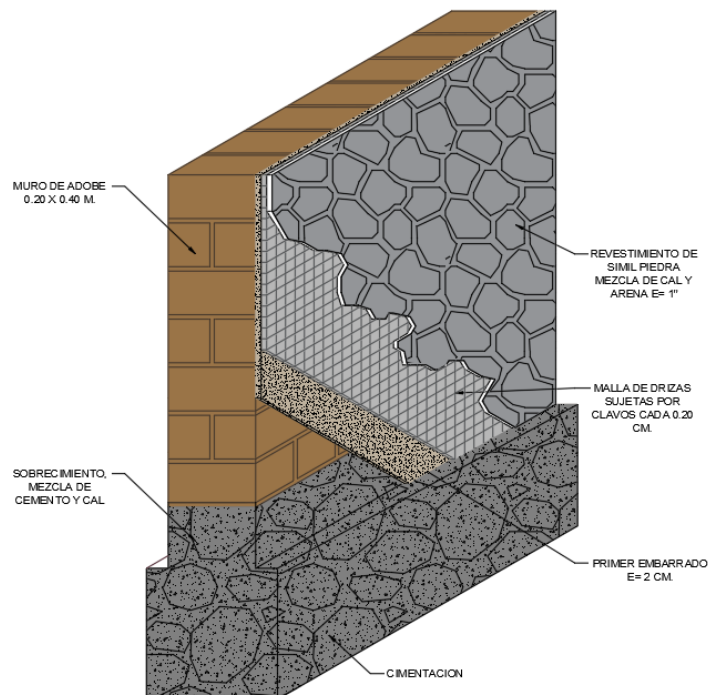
Detalle de revestimiento de símil-piedra en fachadas
